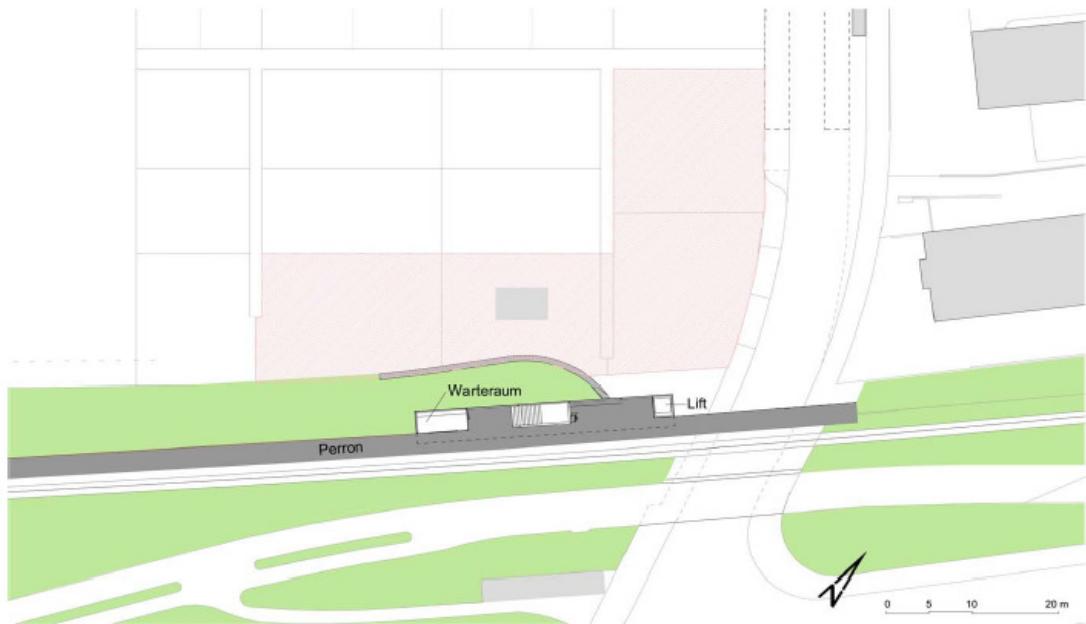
Grundriss Perronniveau Riehen Niederholz
